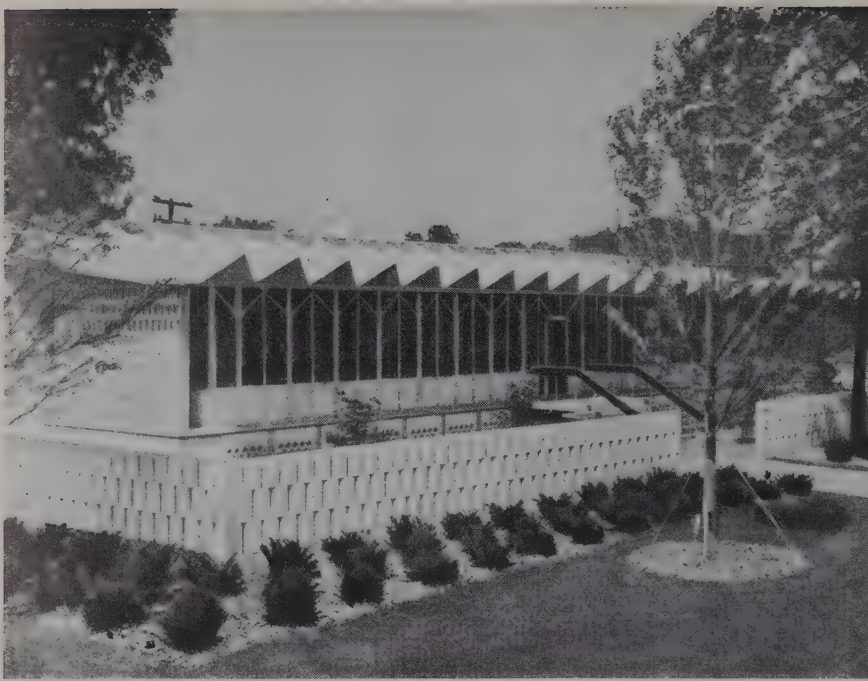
Institut für Stahlbeton in Detroit (USA)
